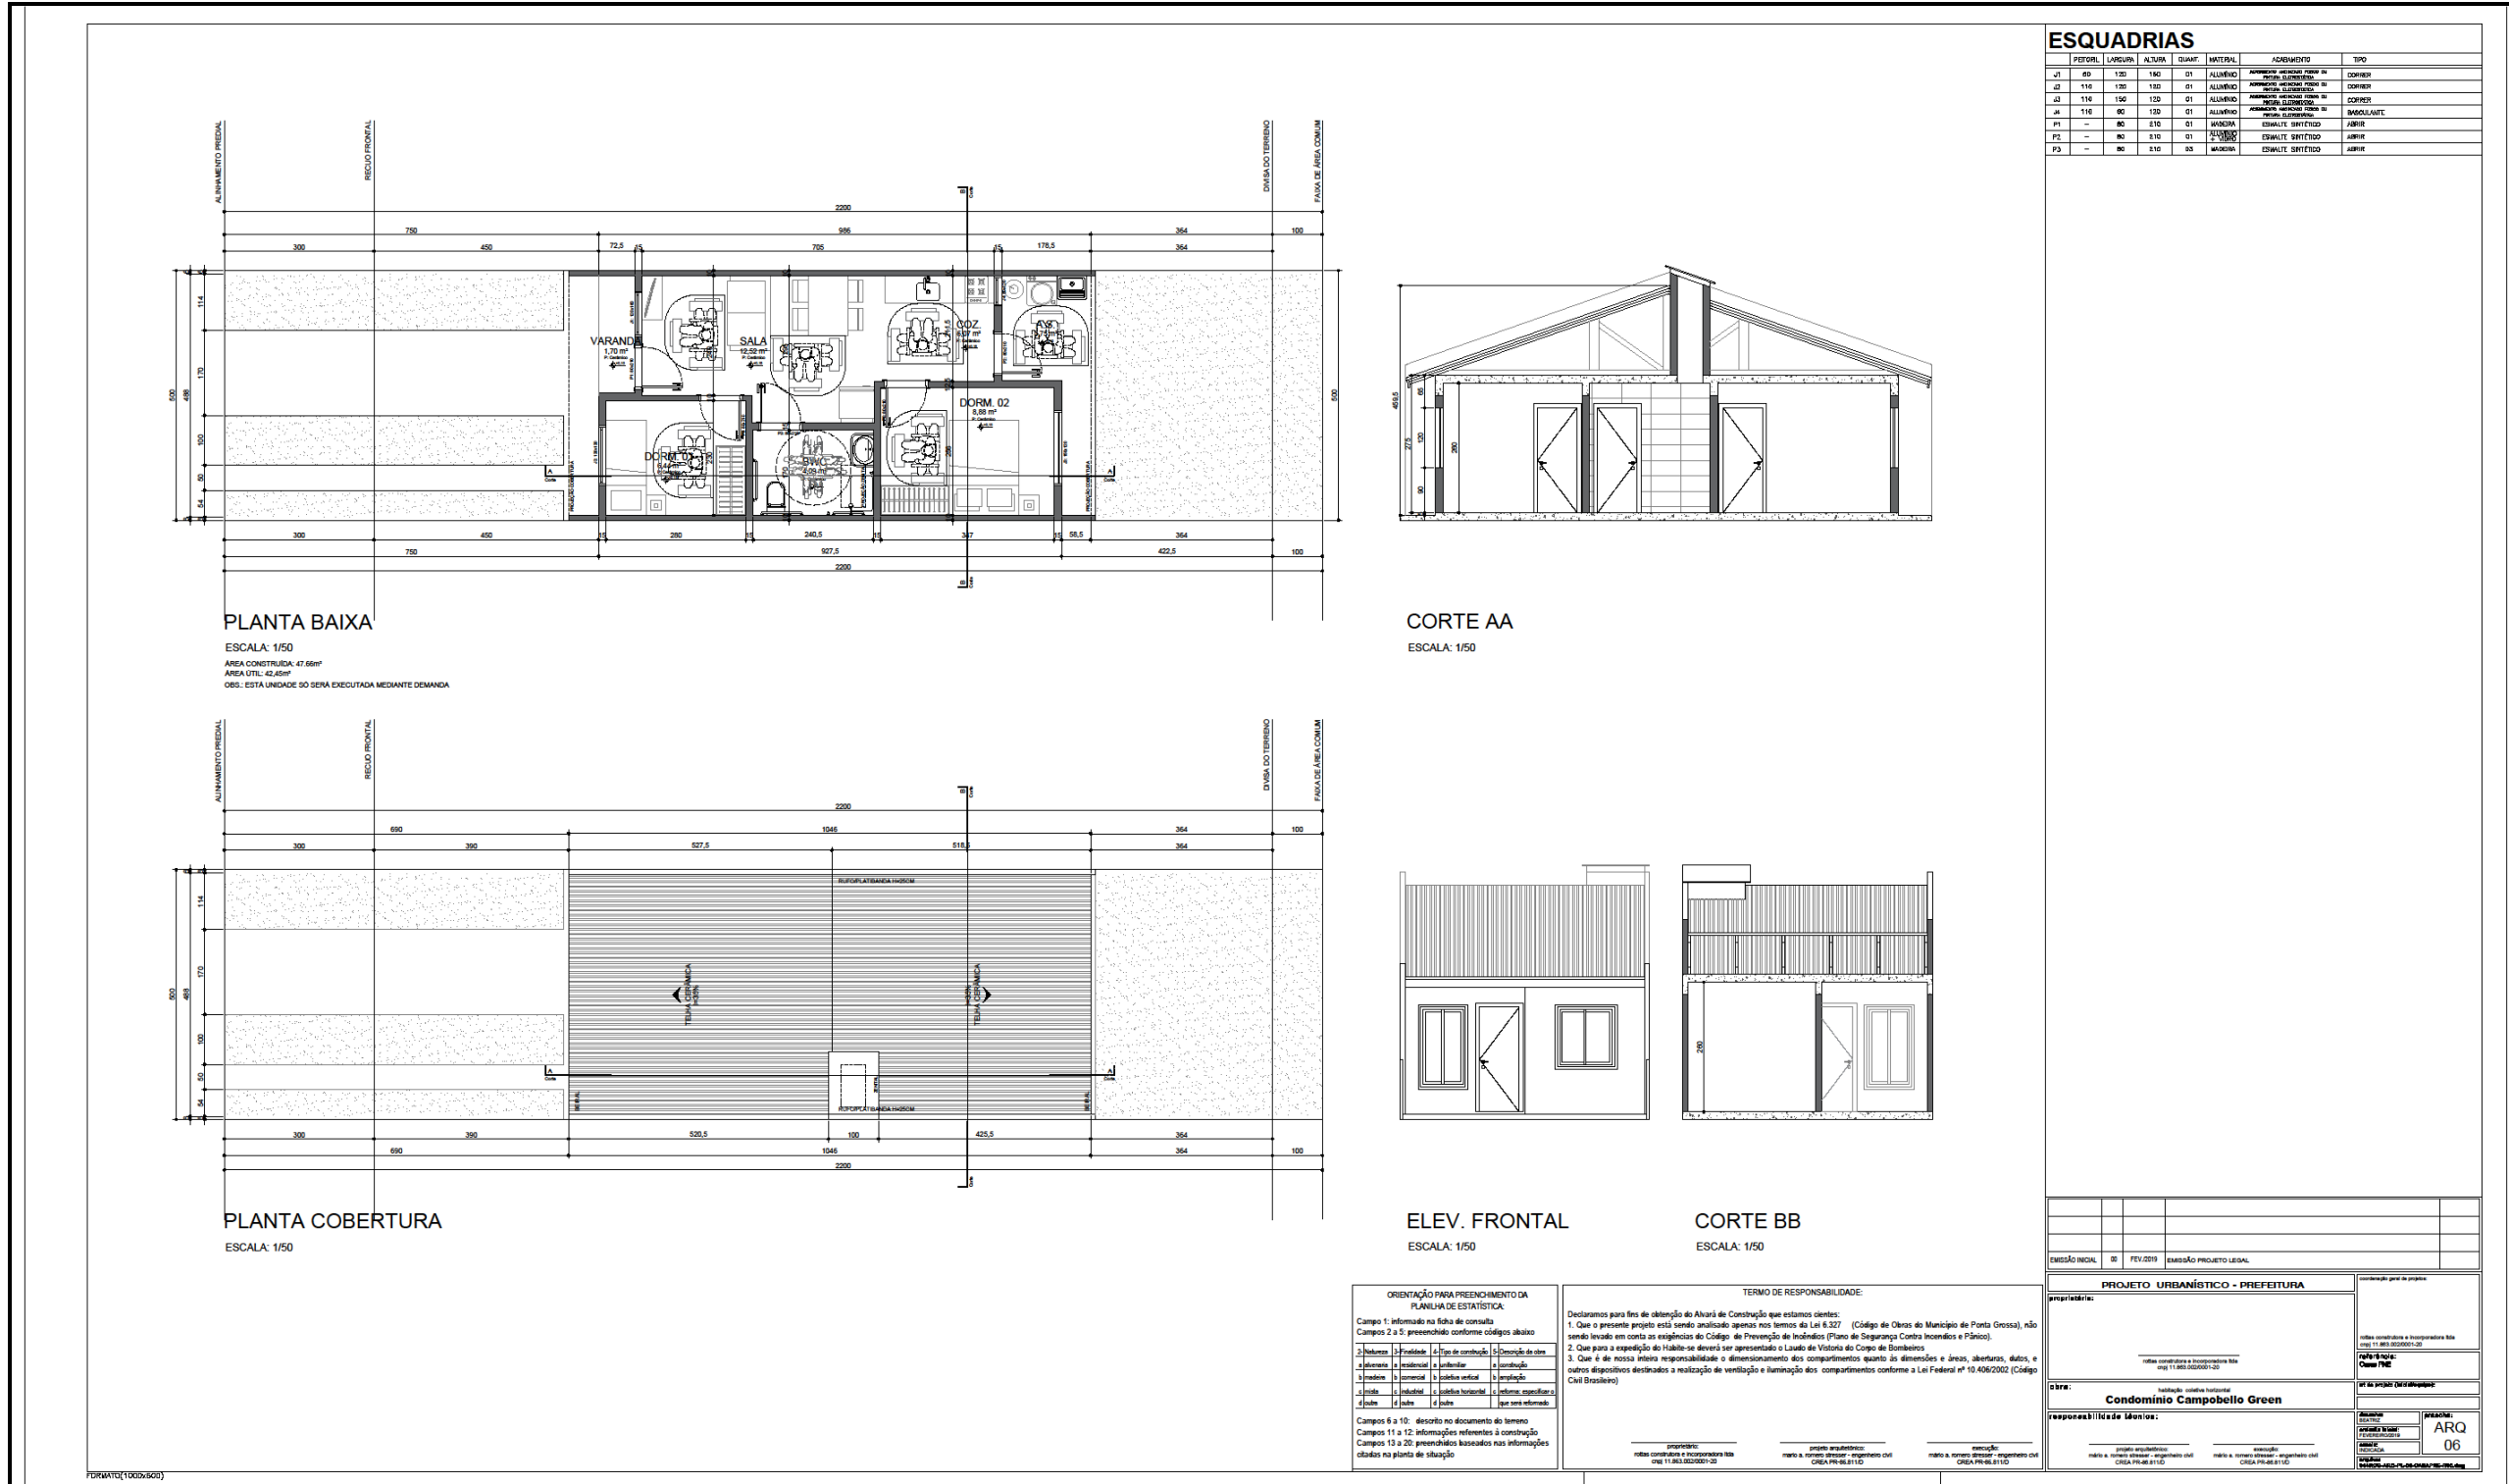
Planta baixa, planta de cobertura, elevação frontal, cortes AA e BB – Residências Tipo 03
